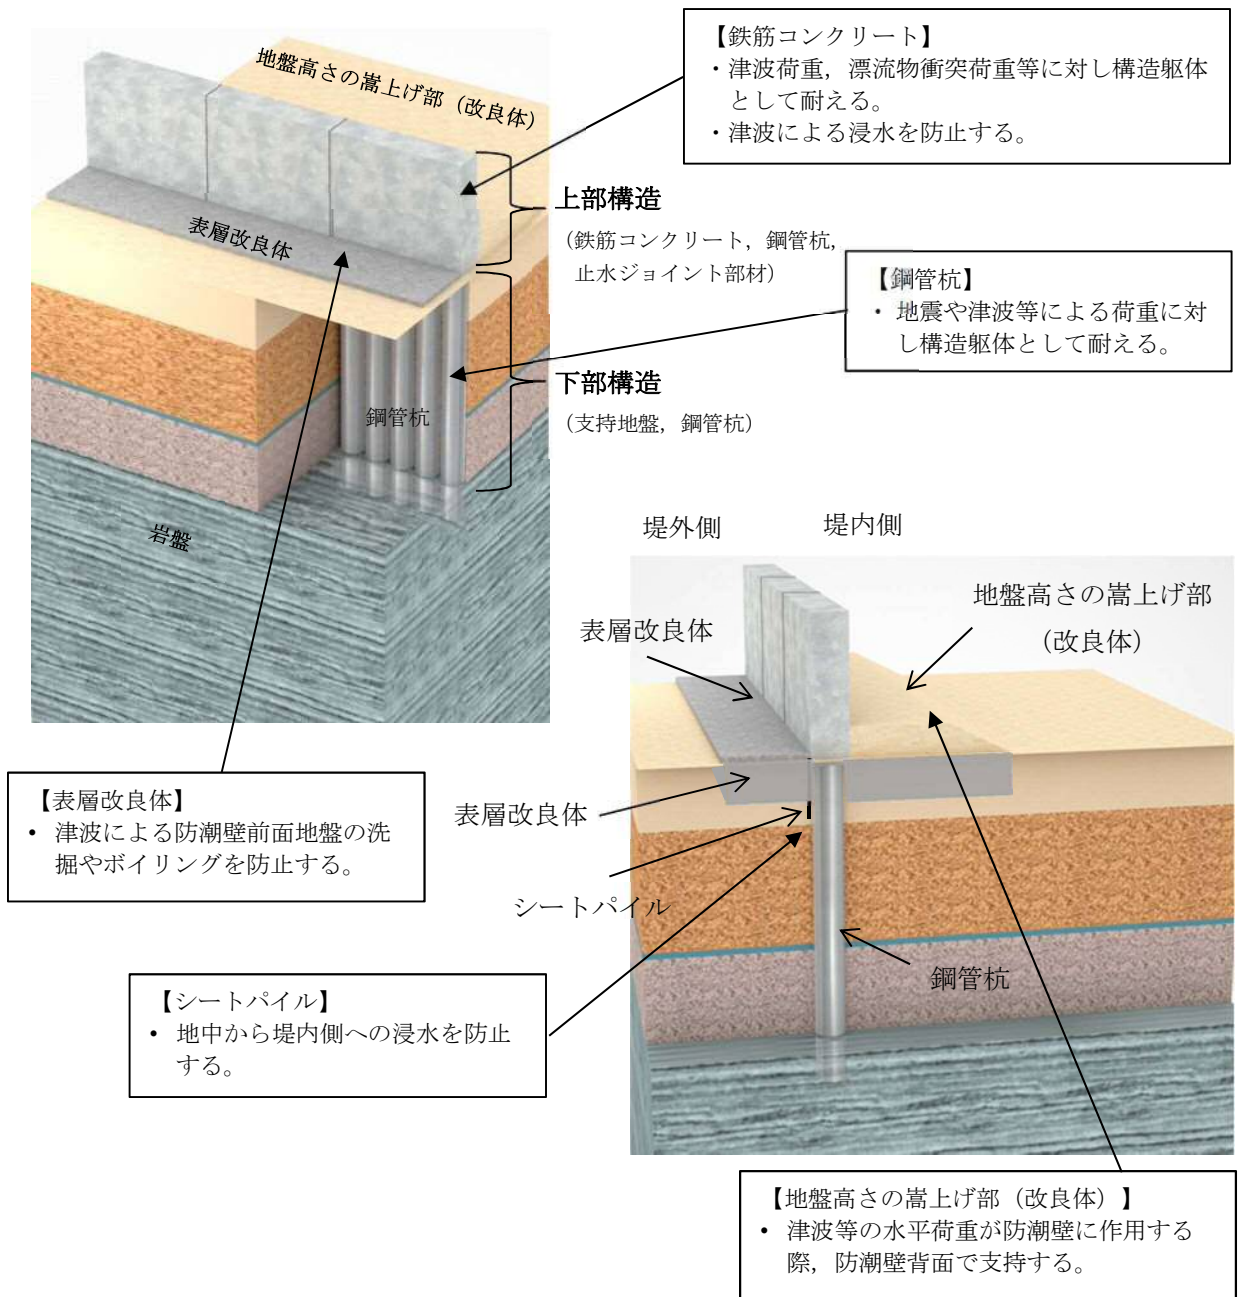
(2) 鋼管杭鉄筋コンクリート防潮壁の構造概要図 (2/2)
